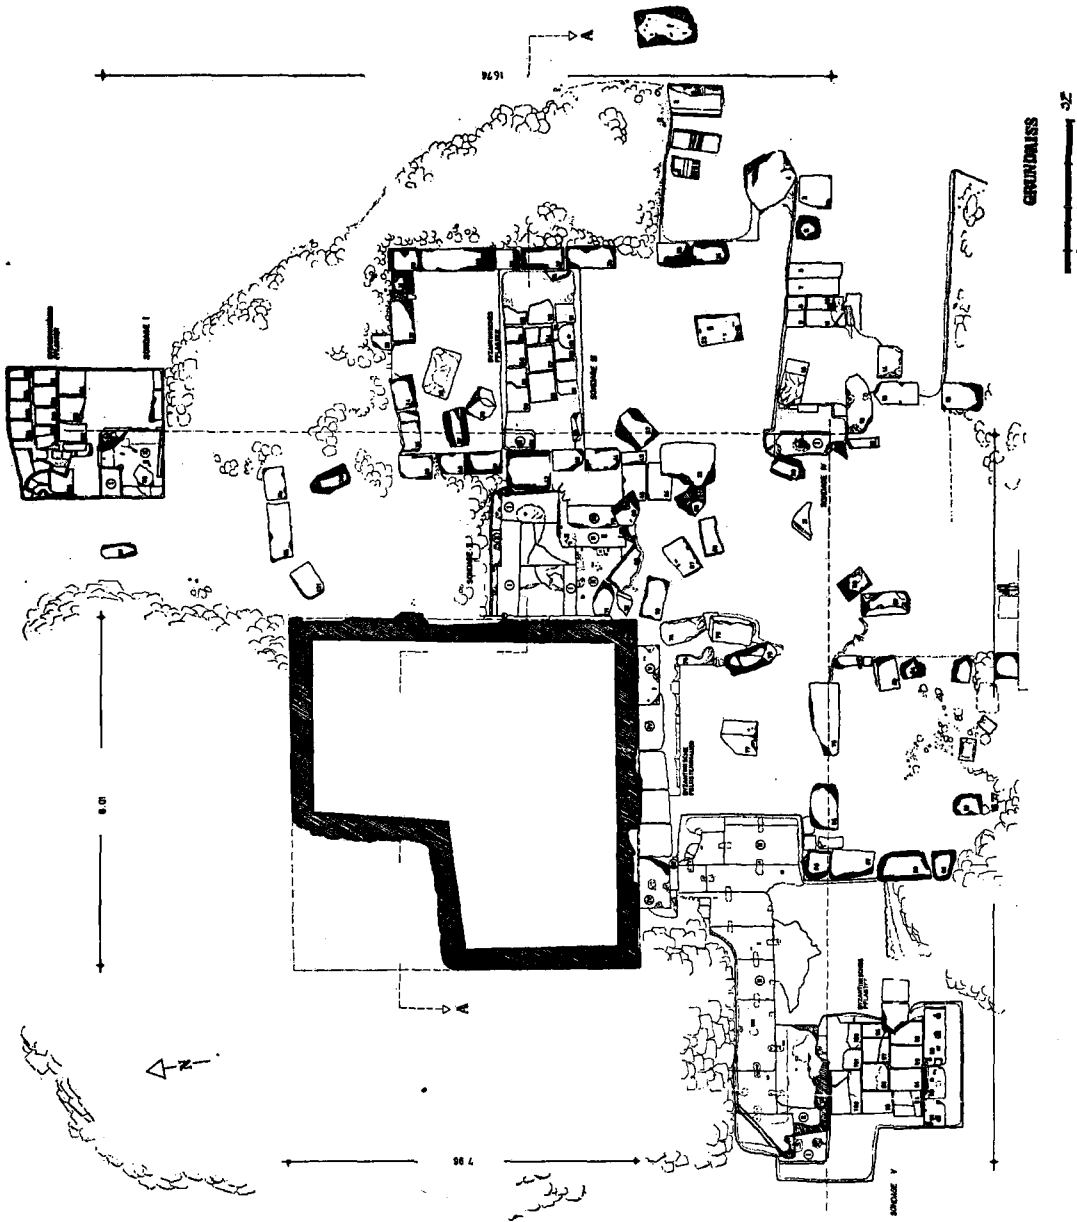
Grundriss des Kenotaph (K. Schulz)
